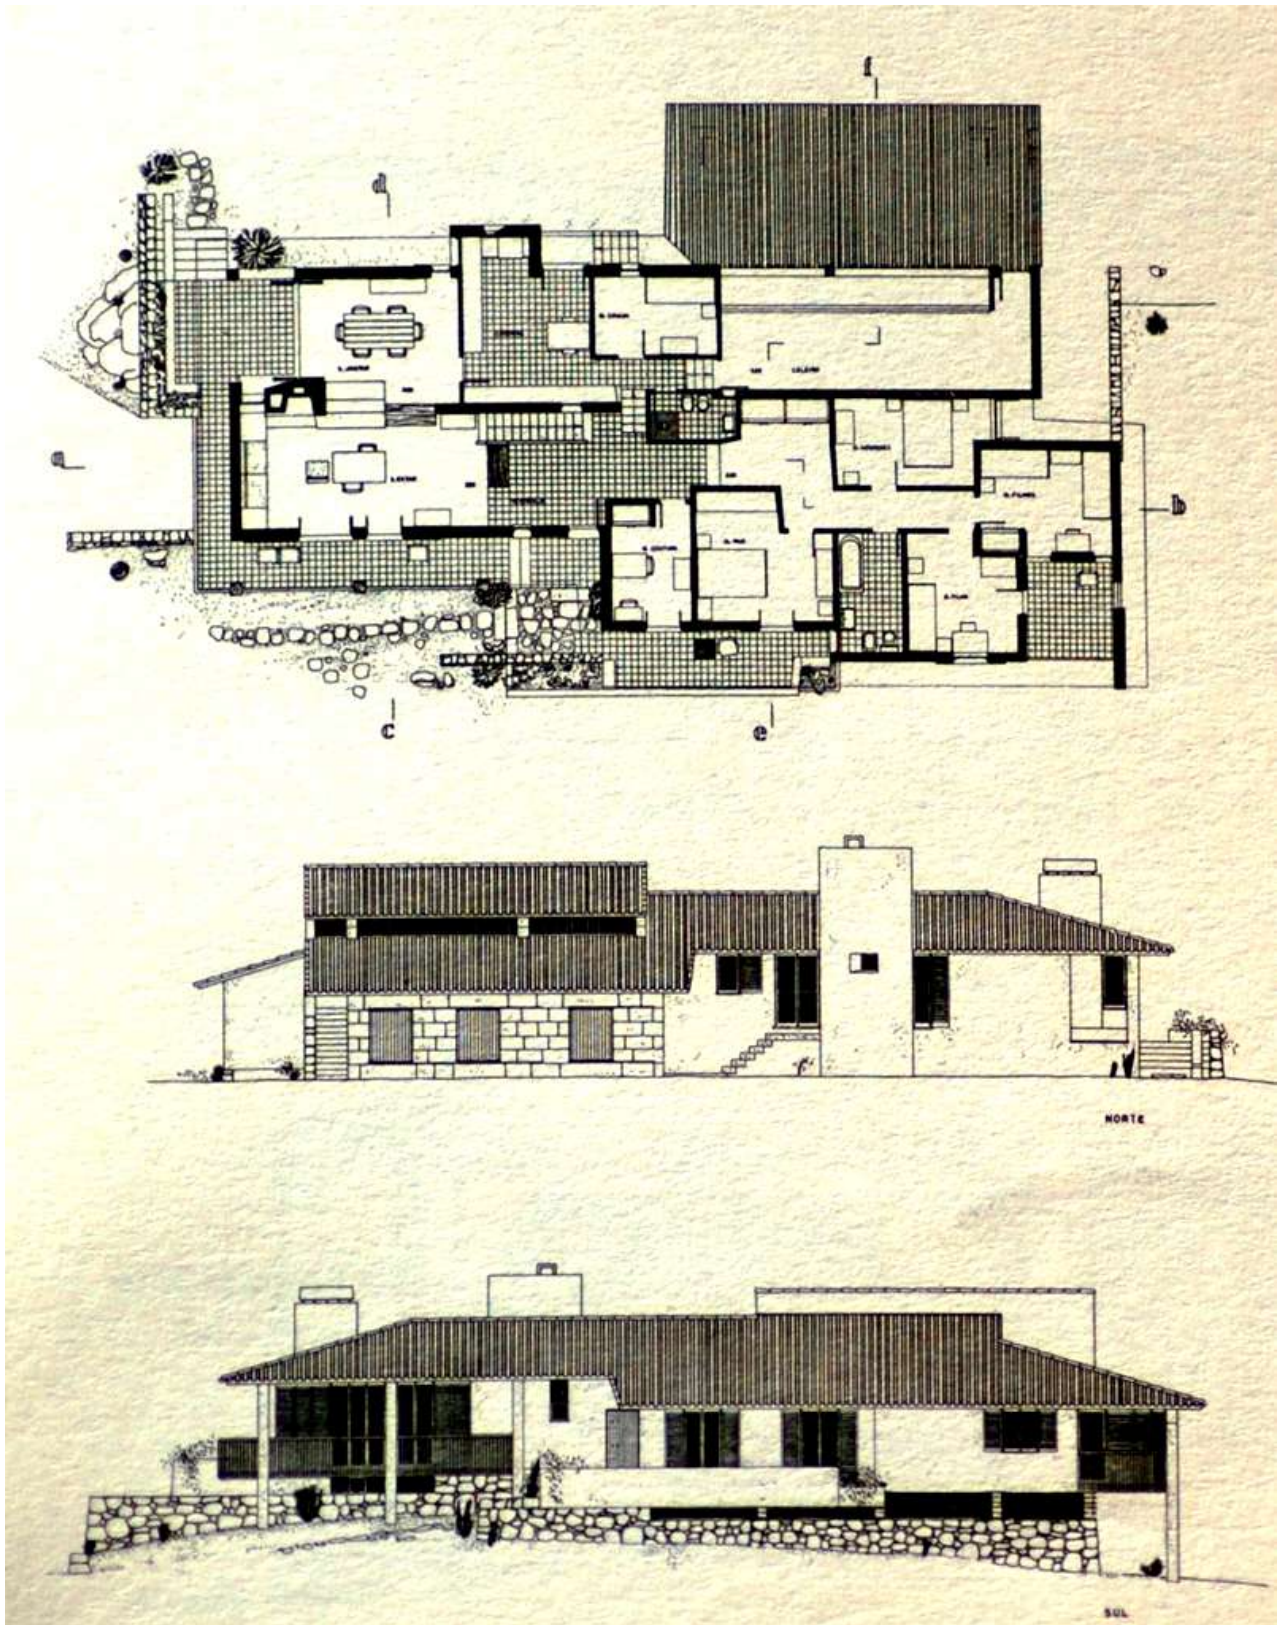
"Habitação rural", Rolando Torgo, planta e alçados (revista rA, pág. 59).
